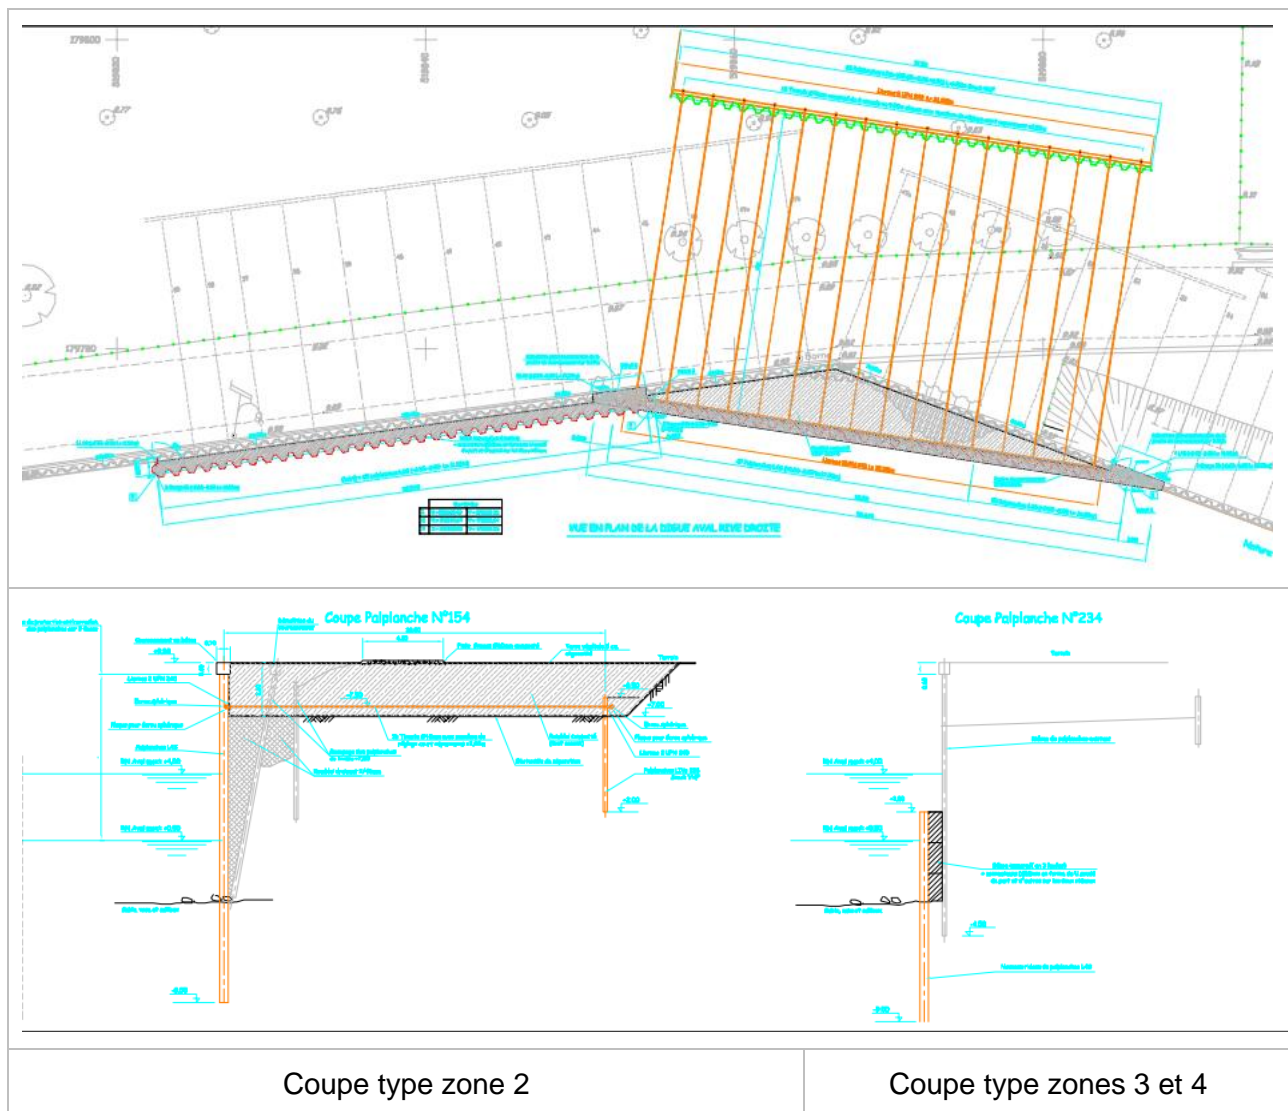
Travaux de confortement du rideau de palplanches aval rive droite
